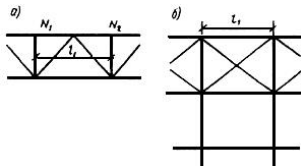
Схемы для определения расчетной длины пояса фермы из плоскости
